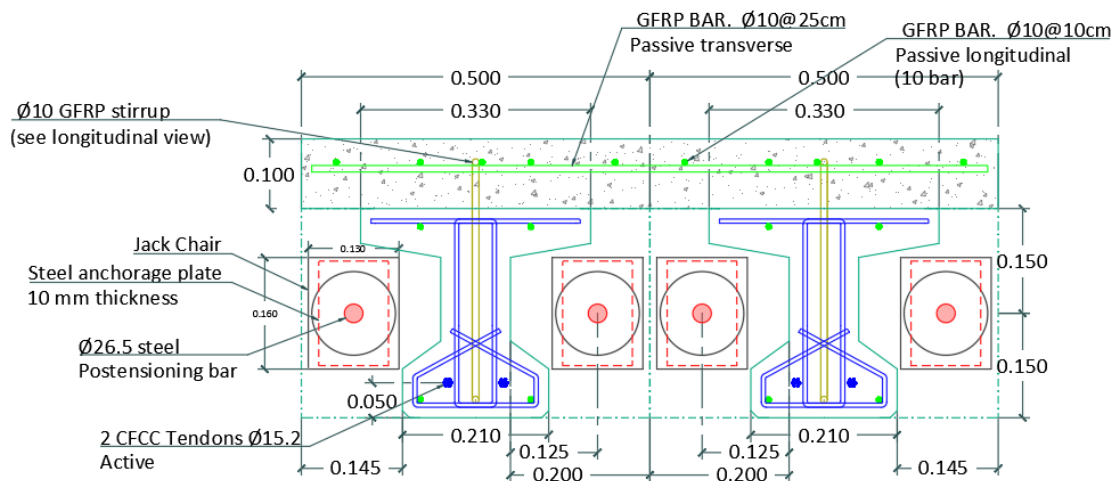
Sección y armadura de la sección compuesta
